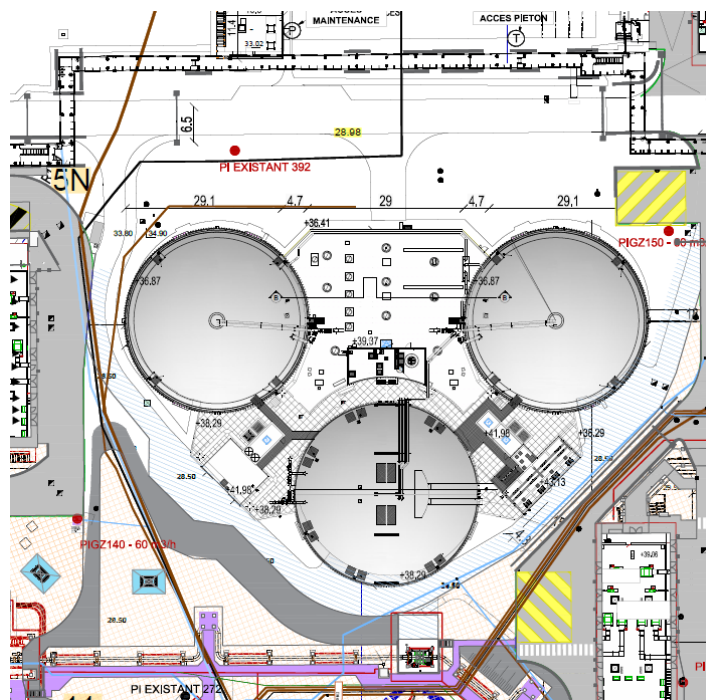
Plan d'implantation de l'atelier HOMO après refonte
